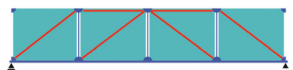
Statisches System des Stahlglasträgers (Fachwerk)
